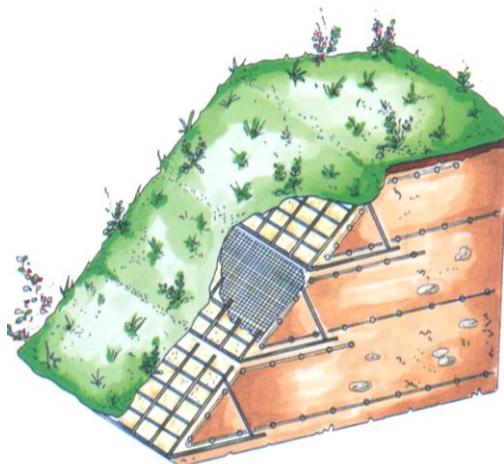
Обеспечение устойчивости откоса насыпи посредством армирования грунта
